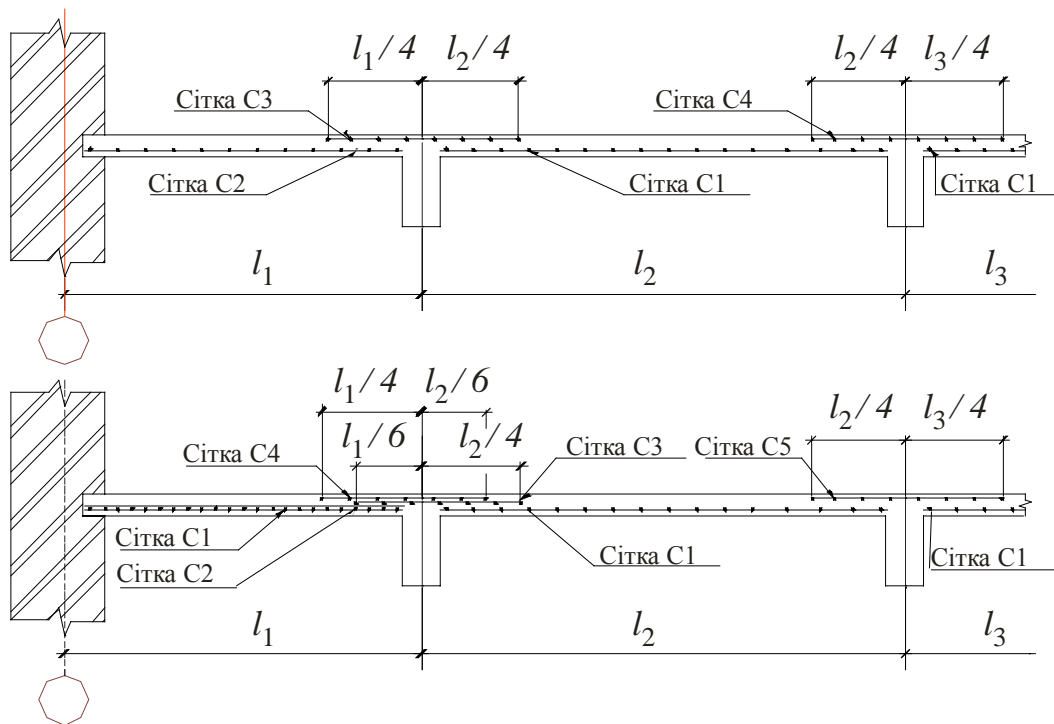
Армування плит зварними сітками з поперечною робочою арматурою (варіанти)
